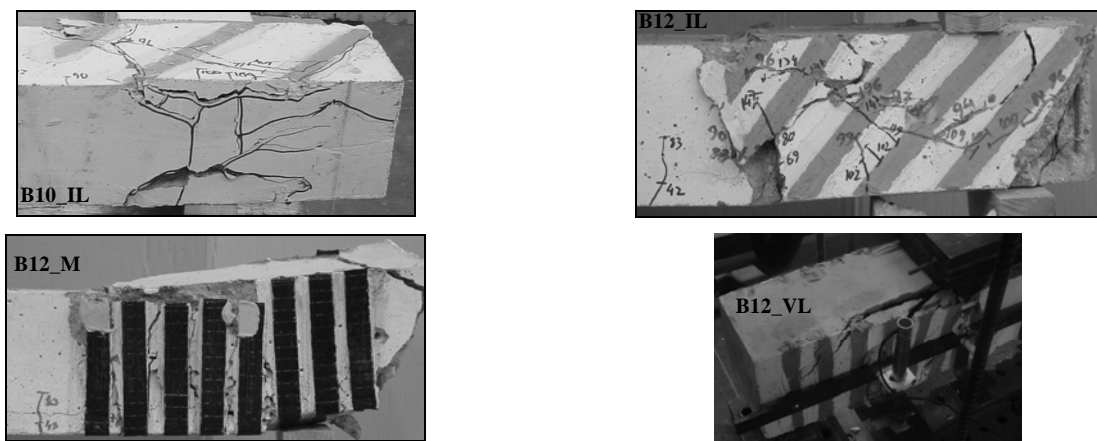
Pormenor dos modos de rotura das vigas B10_IL, B12_IL, B12_M e B12_VL.
